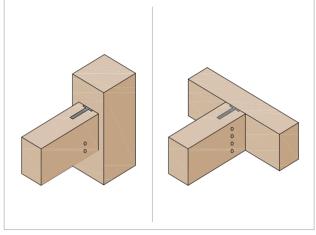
Collegamento trave-trave e trave-pilastro con piastre a scomparsa.
